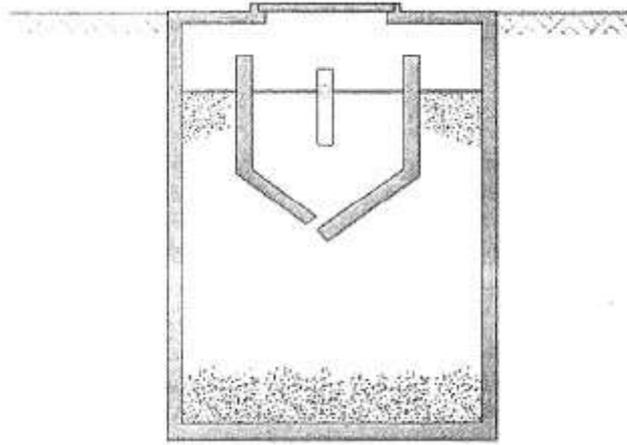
Decanto-digestor de câmaras sobrepostas (corte transversal)
